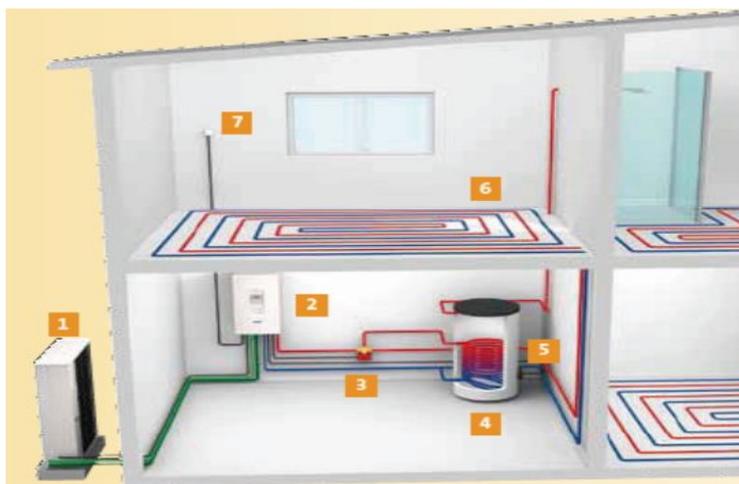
Схема использования теплового насоса, работающего по схеме «воздух — вода»:
